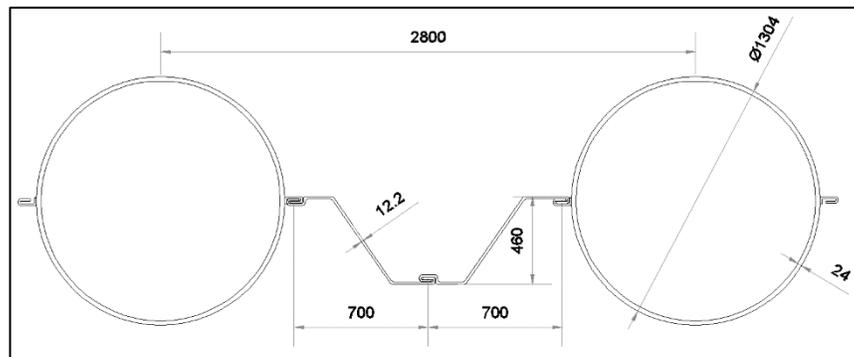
Sección tipo de la tablaestaca a utilizar en la pared interior, del sistema combinado de doble muro.
